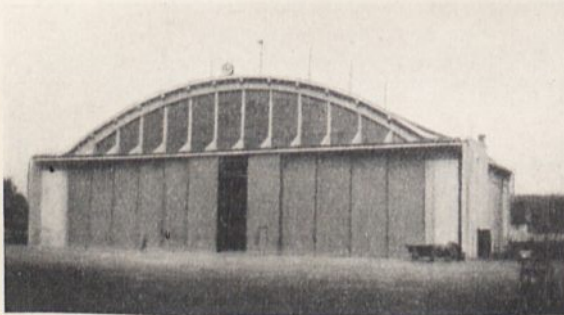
Eisenbeton-Flugzeughalle mit Schiebetor.
